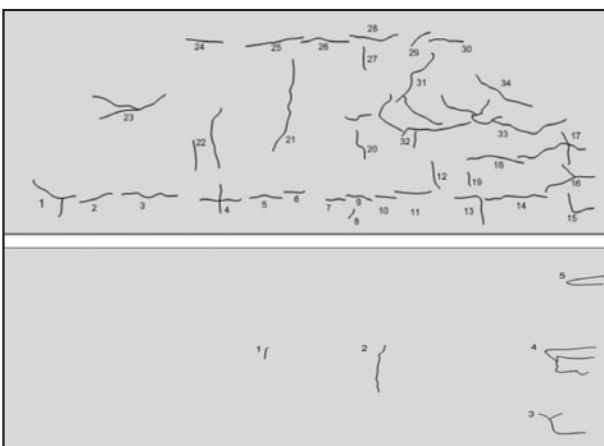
Rissbilder in den Schwindplatten mit Beton A-Ref (oben) und mit Beton A-2 (unten)
